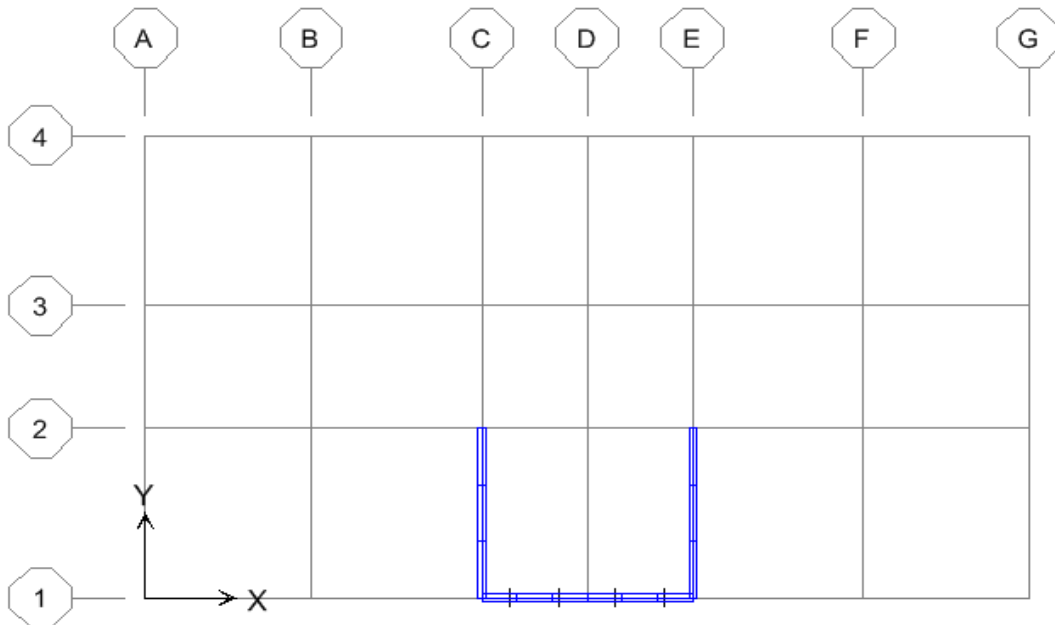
Disposition du noyau en béton armé de la structure en (R+2)
